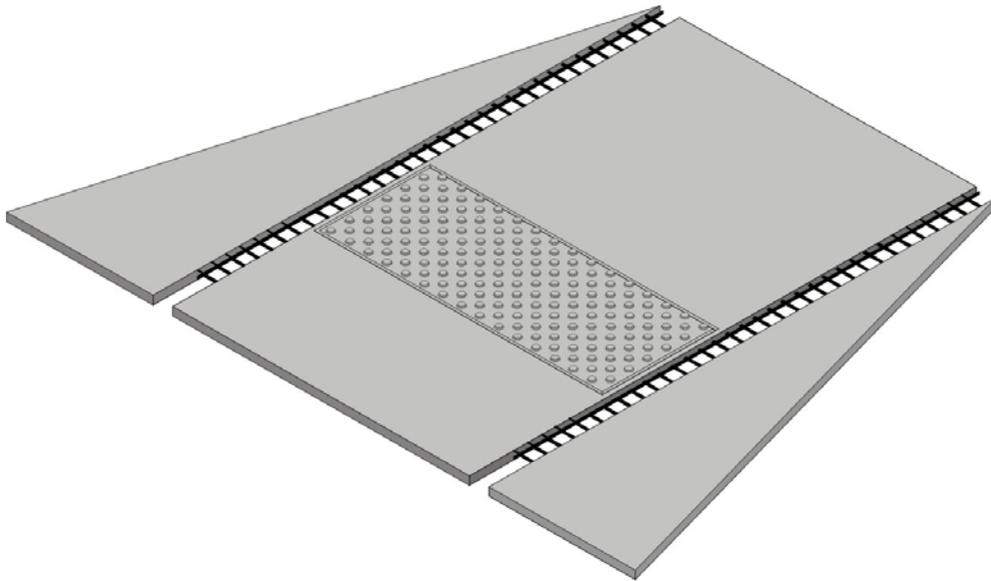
Desenho esquemático da rampa pré-fabricada especial após a desforma, onde é possível se observar às faixas de armadura sem cobertura em microconcreto
